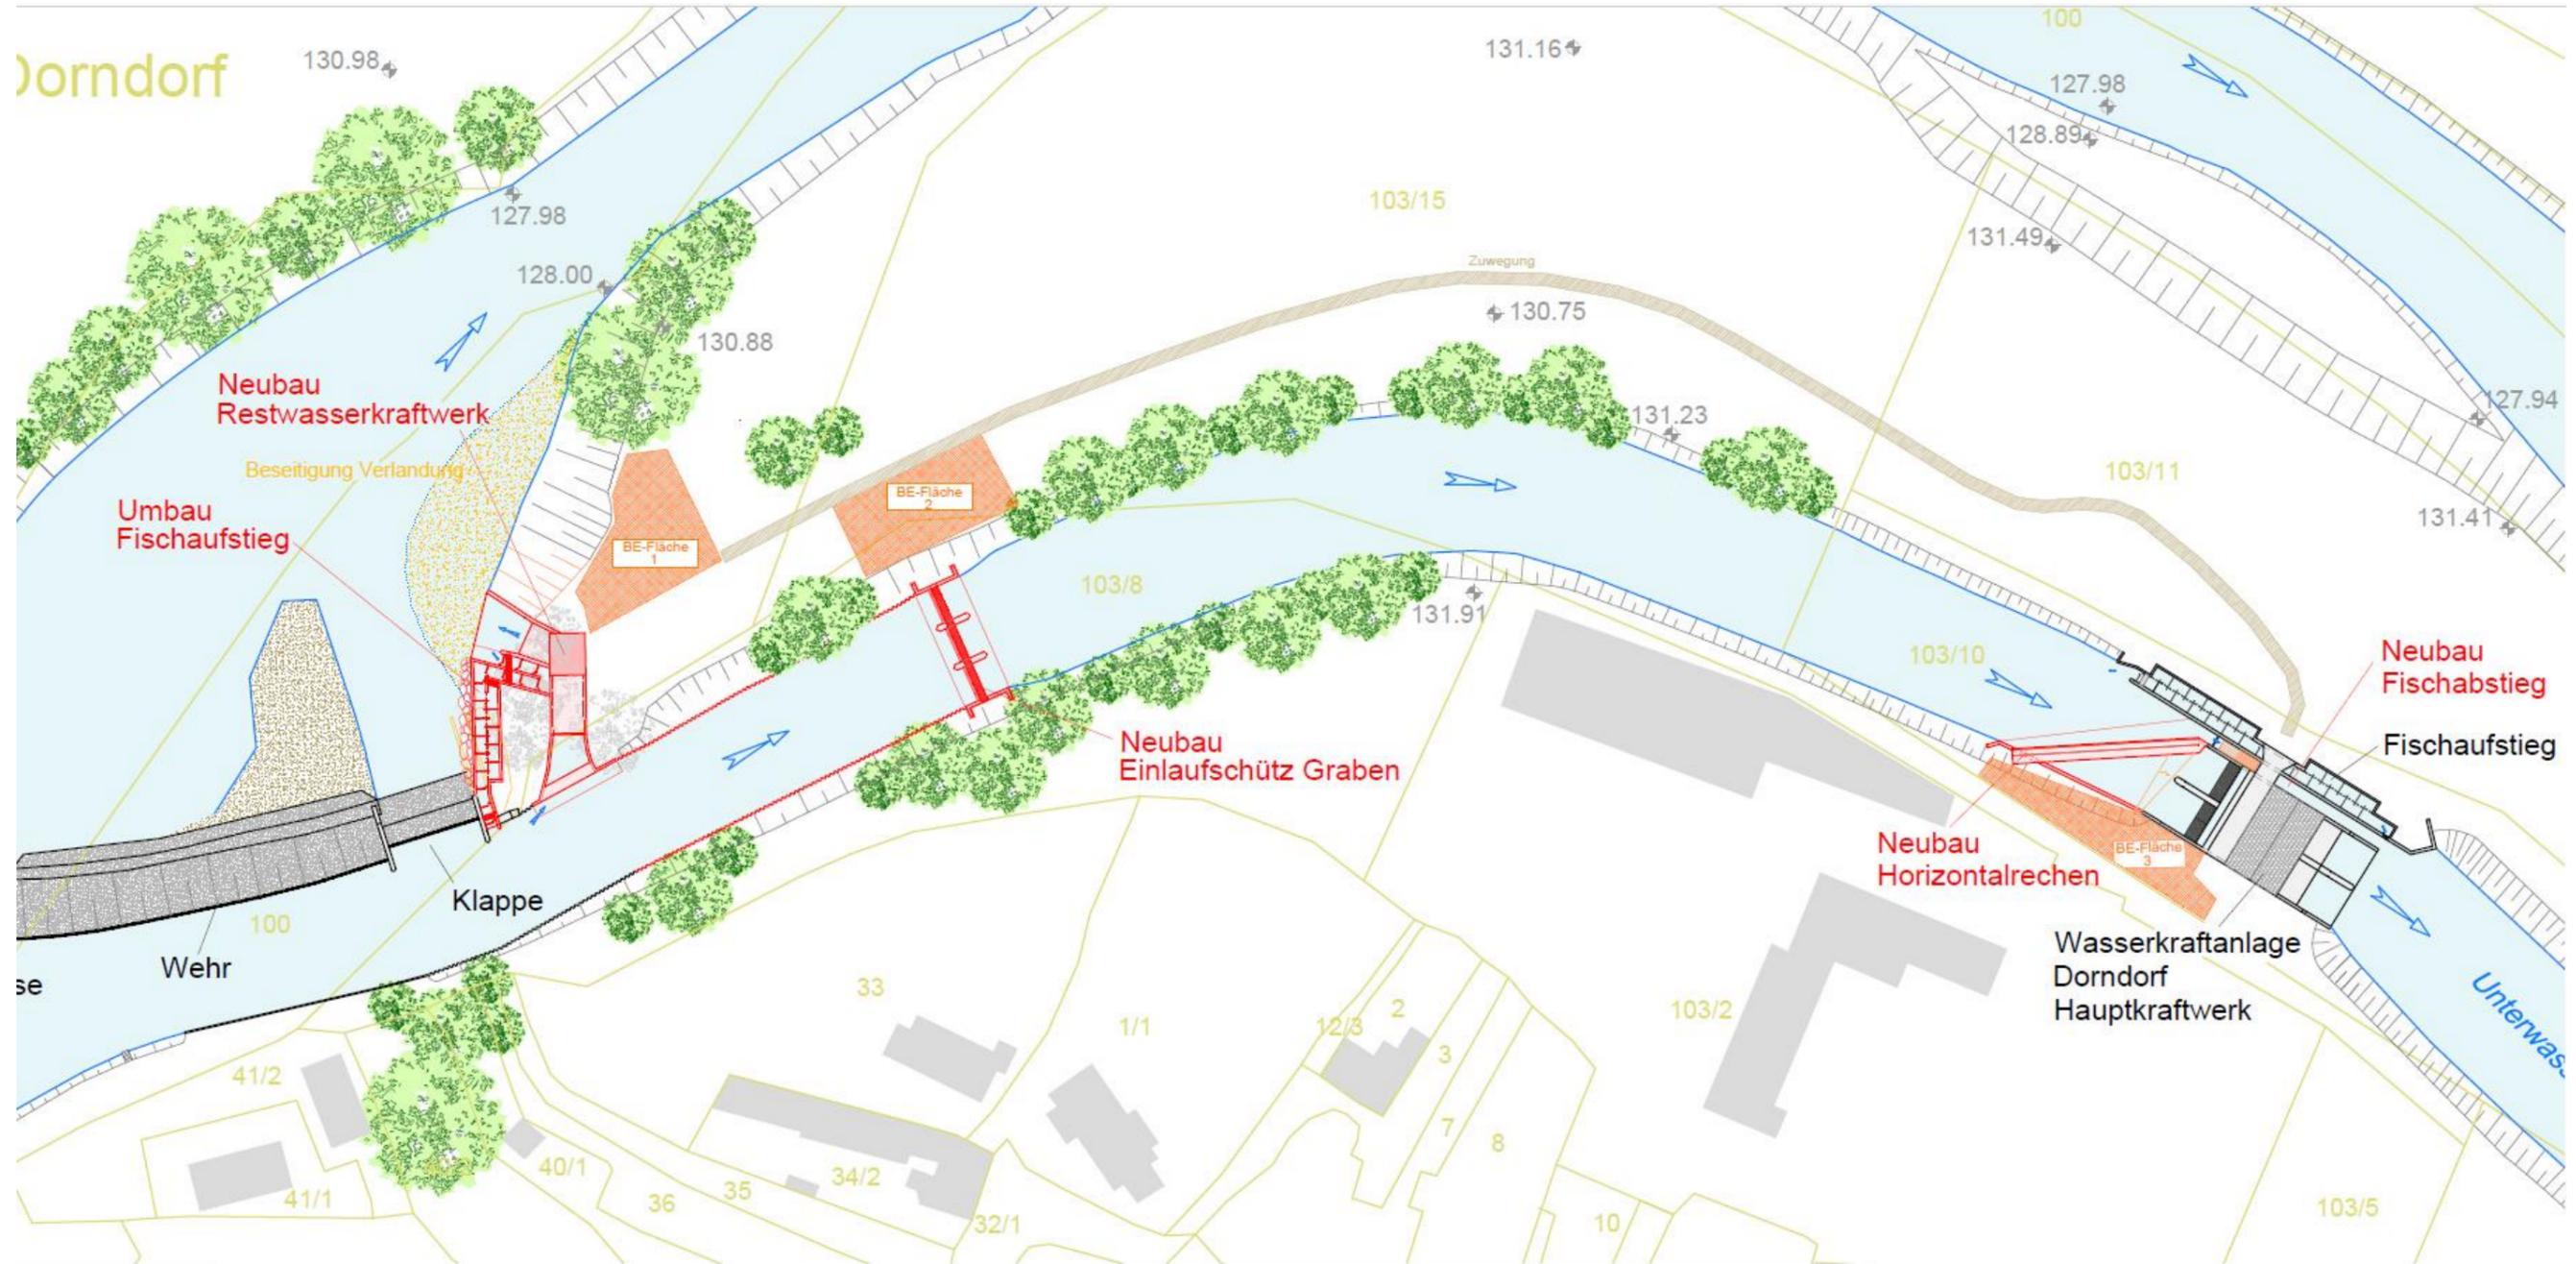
Lageplan Bauvorhaben (aus: Planungsunterlagen der IGW mbH)
